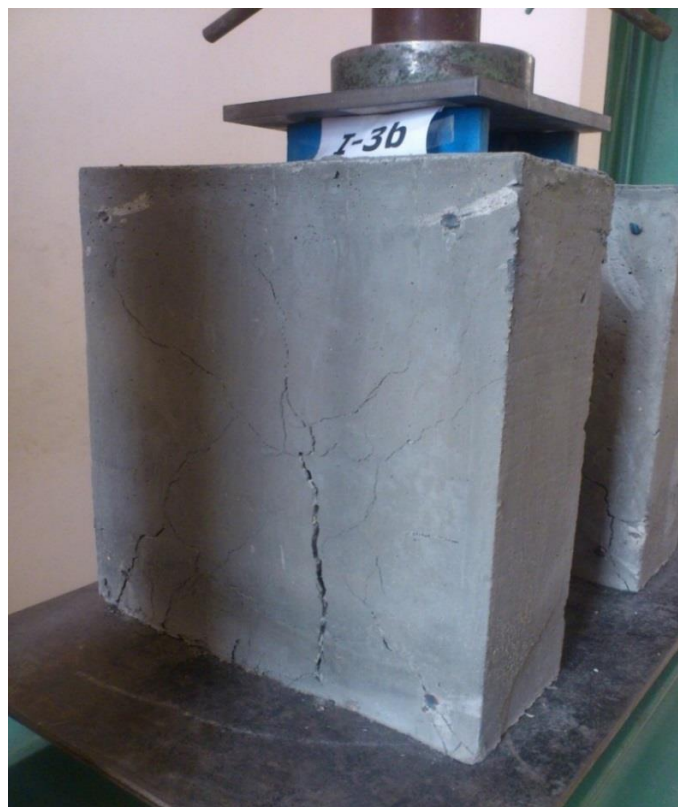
Rupture par fissuration et écrasement du béton.
